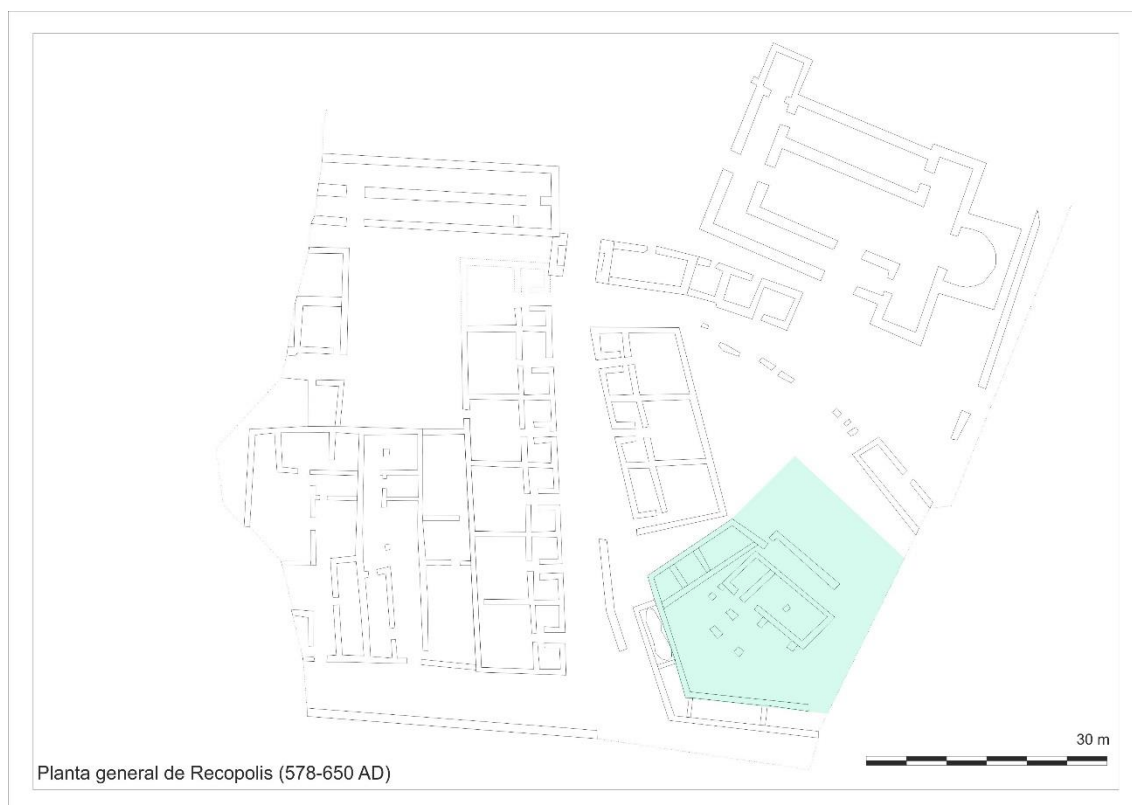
Situación de la vivienda 15.5000 en la planta general del yacimiento
